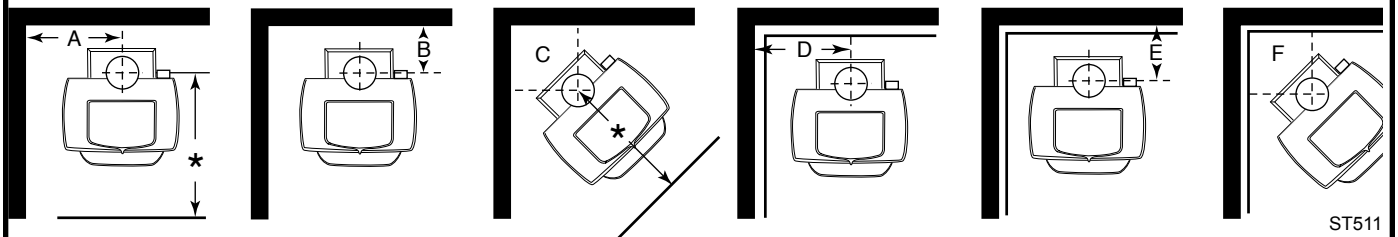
Installation en coin, connecteur vertical de cheminée, deux protecteurs muraux. Espaces libres latéraux réduits. Les protecteurs muraux DOIVENT se rejoindre dans un angle.
